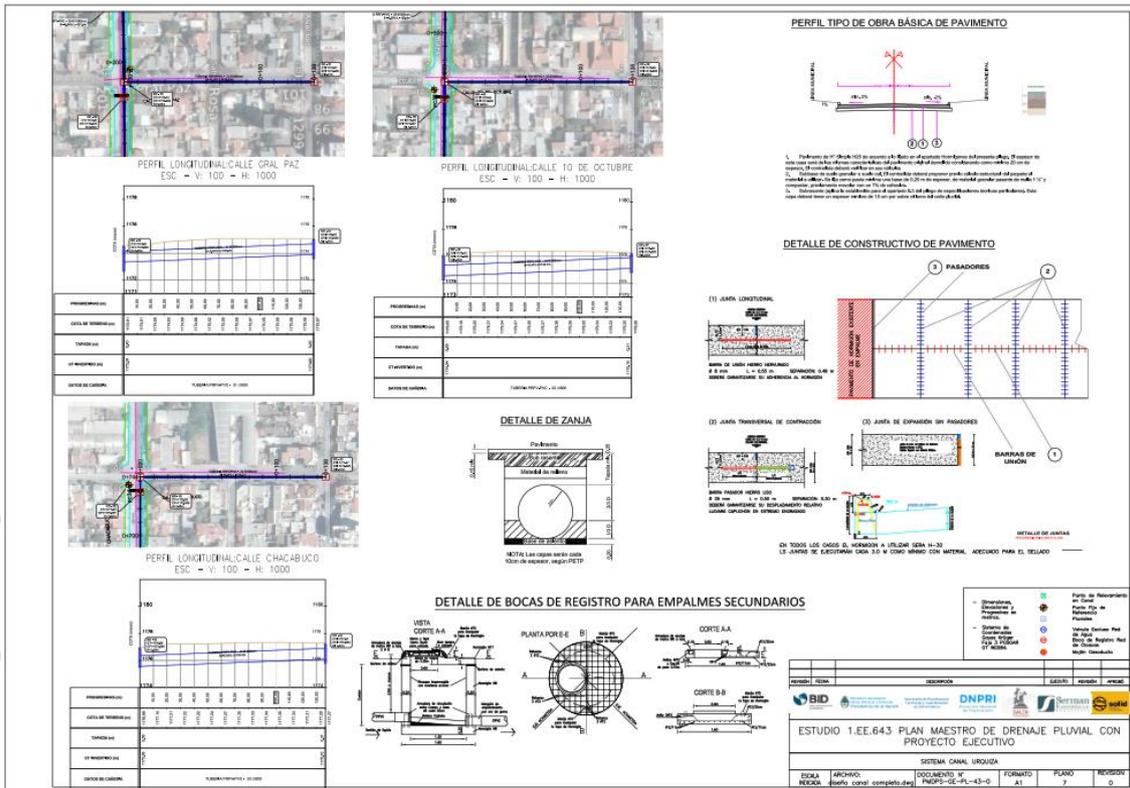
Plan Maestro de drenaje Pluvial – Canal secundario calle Urquiza y canales terciarios
